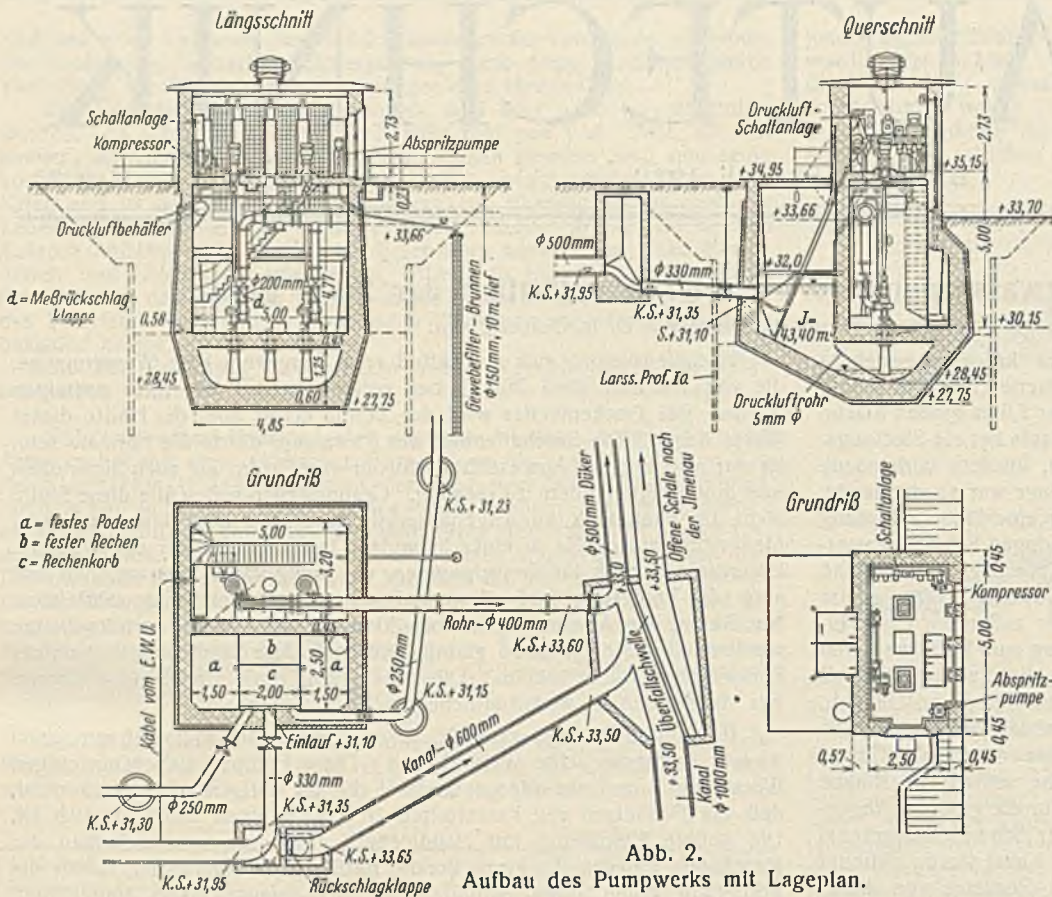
Aufbau des Pumpwerks mit Lageplan.
